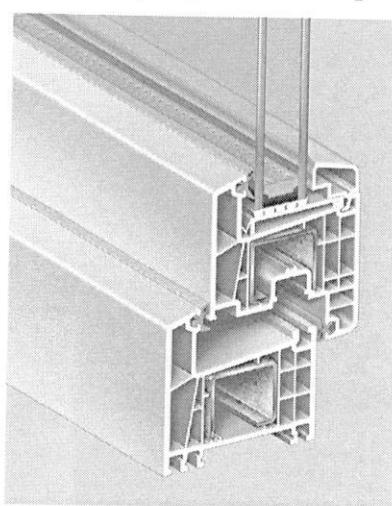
ПВХ профиль однокамерного стеклопакета со стальными вкладышами
